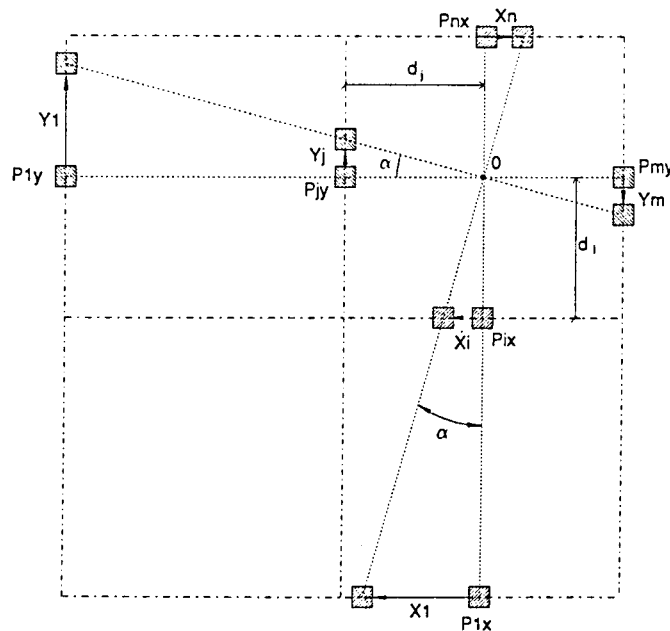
Configuração da instabilidade global - Planta esquemática.
